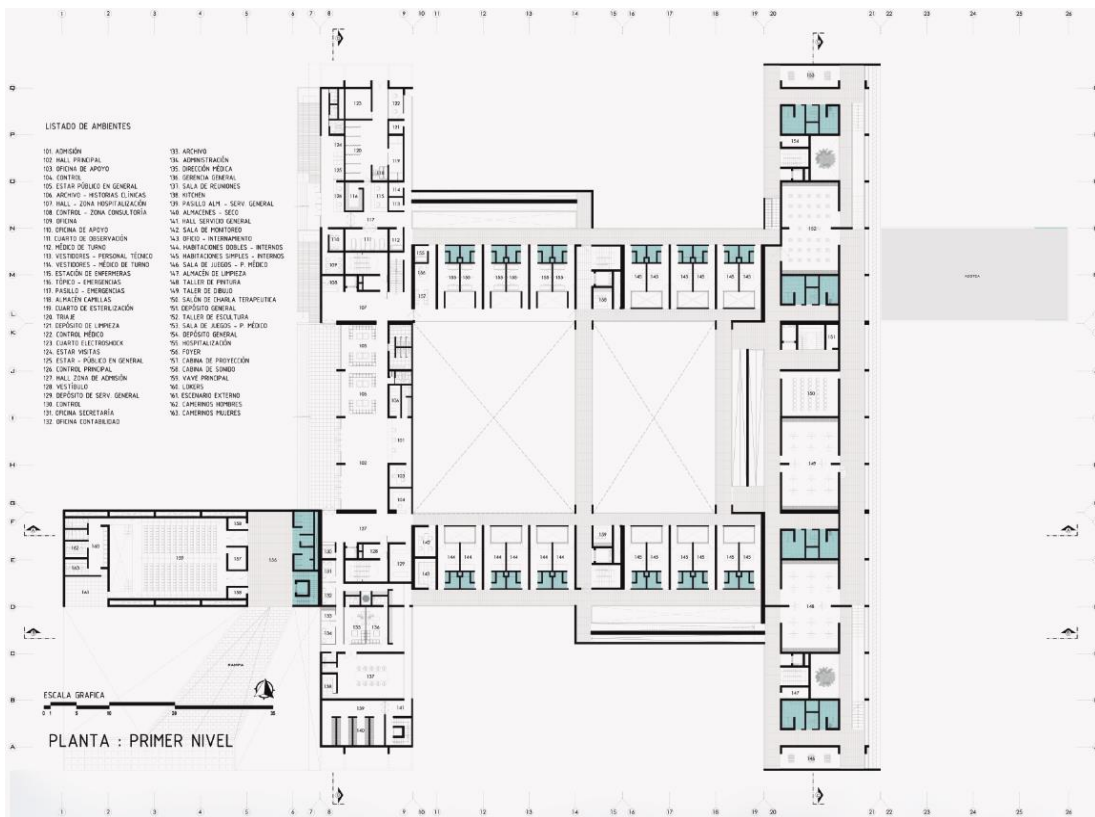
plantas arquitectónicas de la propuesta proyectual.
